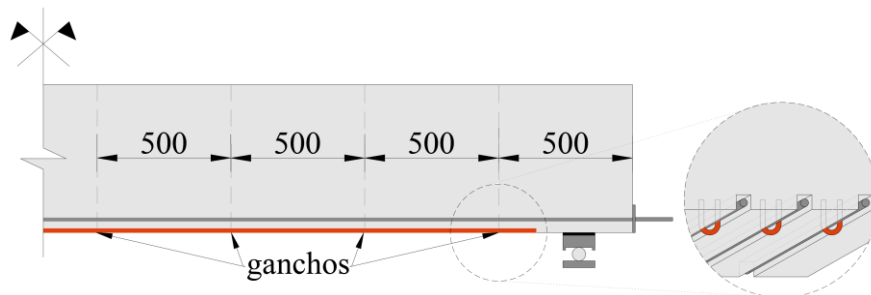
Disposições dos ganchos para a fixação das barras do reforço.
